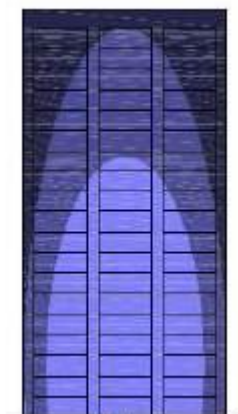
Demonstração de lavado sujo e branco em fachada de edificação
